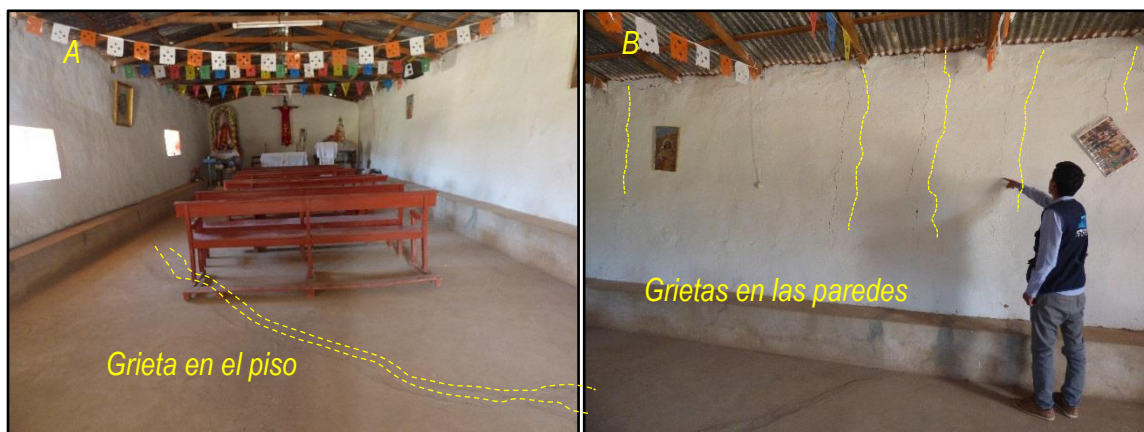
Vista de la iglesia de San Basilio. a) Grieta en el piso de hasta 10 cm de abertura que ha sido rellenado con cemento. b) Grietas en las paredes de 3 cm de abertura.
